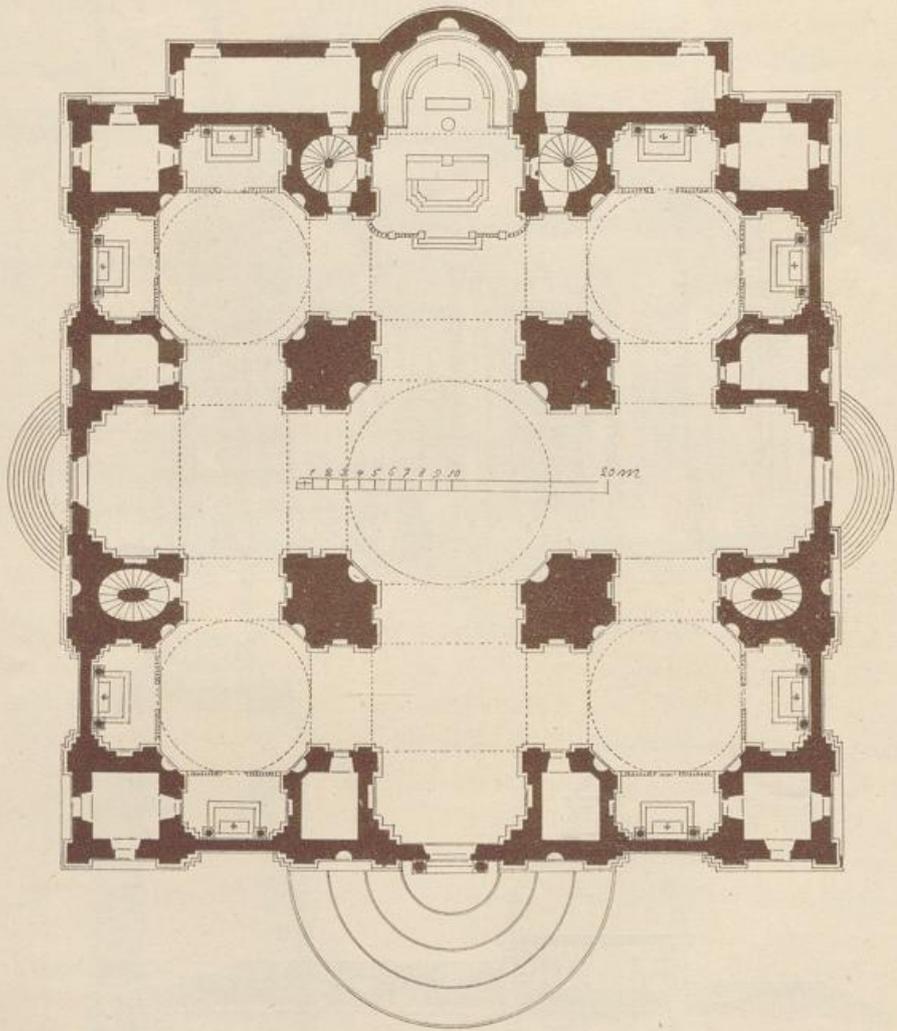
Kirche S. M. di Carignano. Grundriss.
